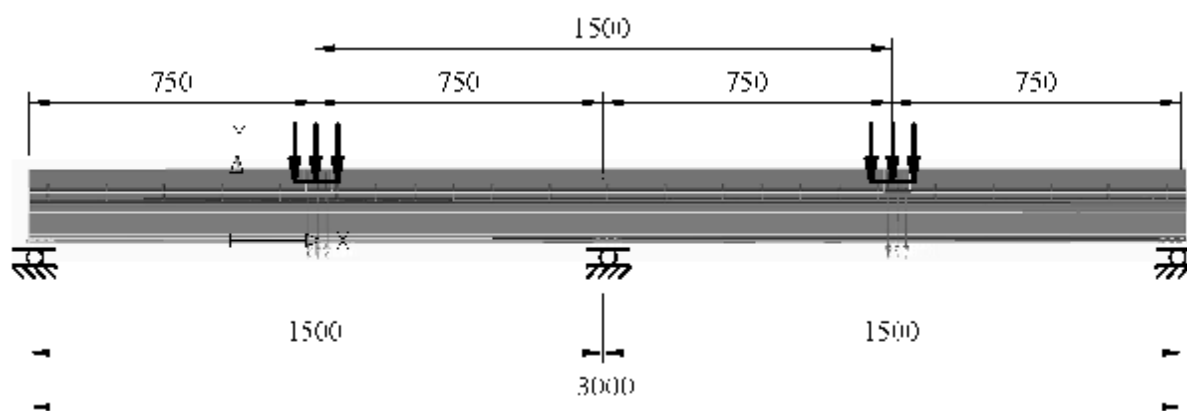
Плоскости приложения нагрузки и опорных связей к моделям двухпролётных сталежелезобетонных балок
